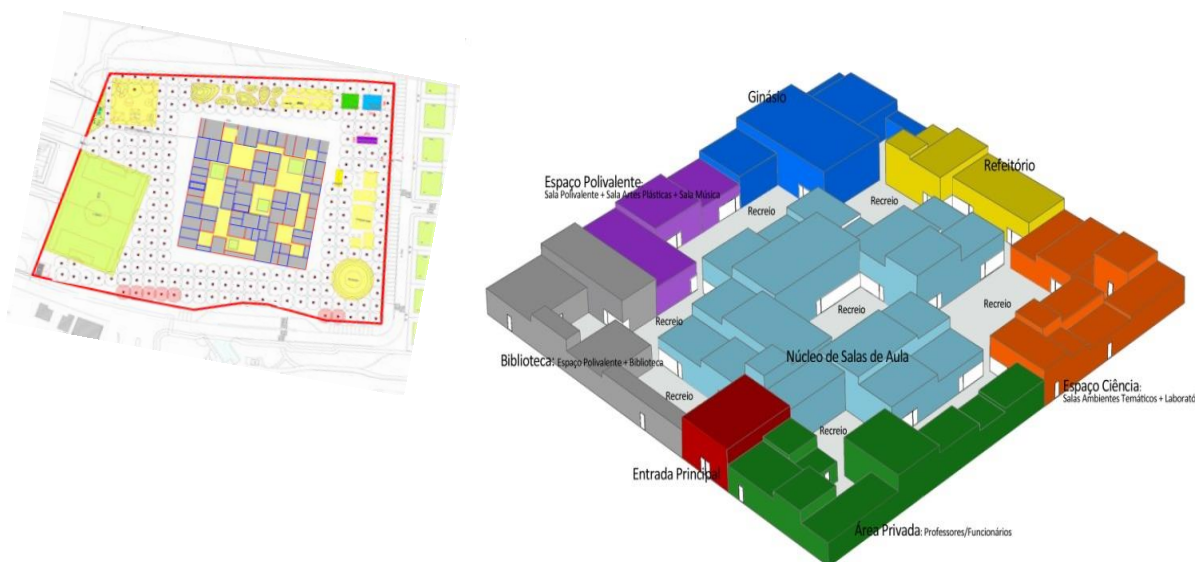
Planta da escola do 1.ºCEB de Vila Nova da Barquinha
